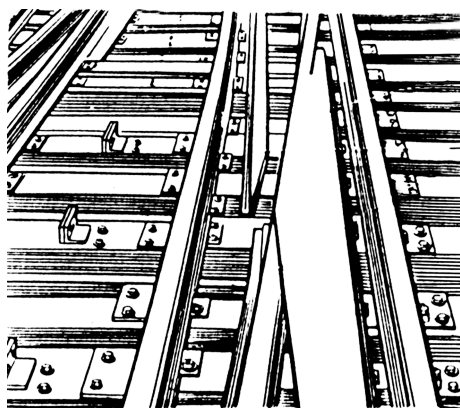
Общий вид тупой крестовины с подвижным сердечником
